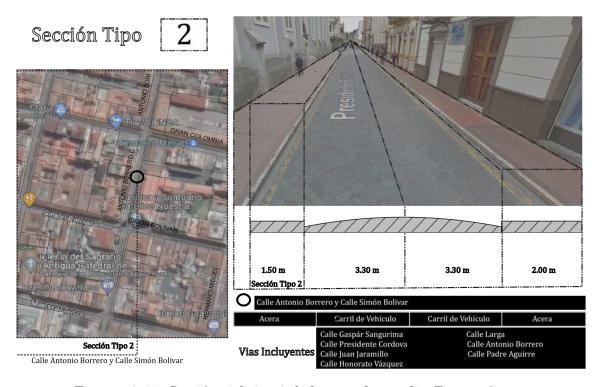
Sección vial tipo 2 de la zona de estudio. Fuente: Autor.
